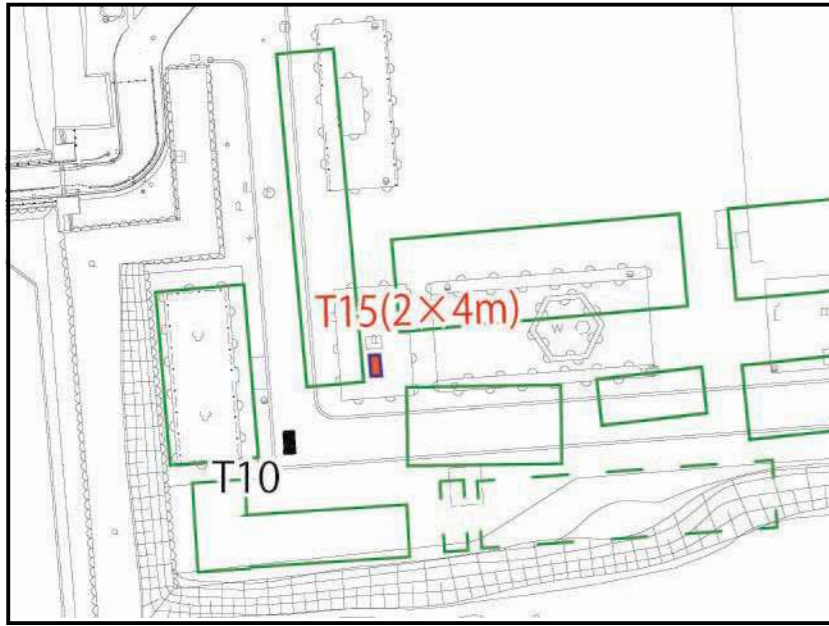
博物館 明治村所蔵「歩兵第六連隊平面図集 平面図」拡大図
